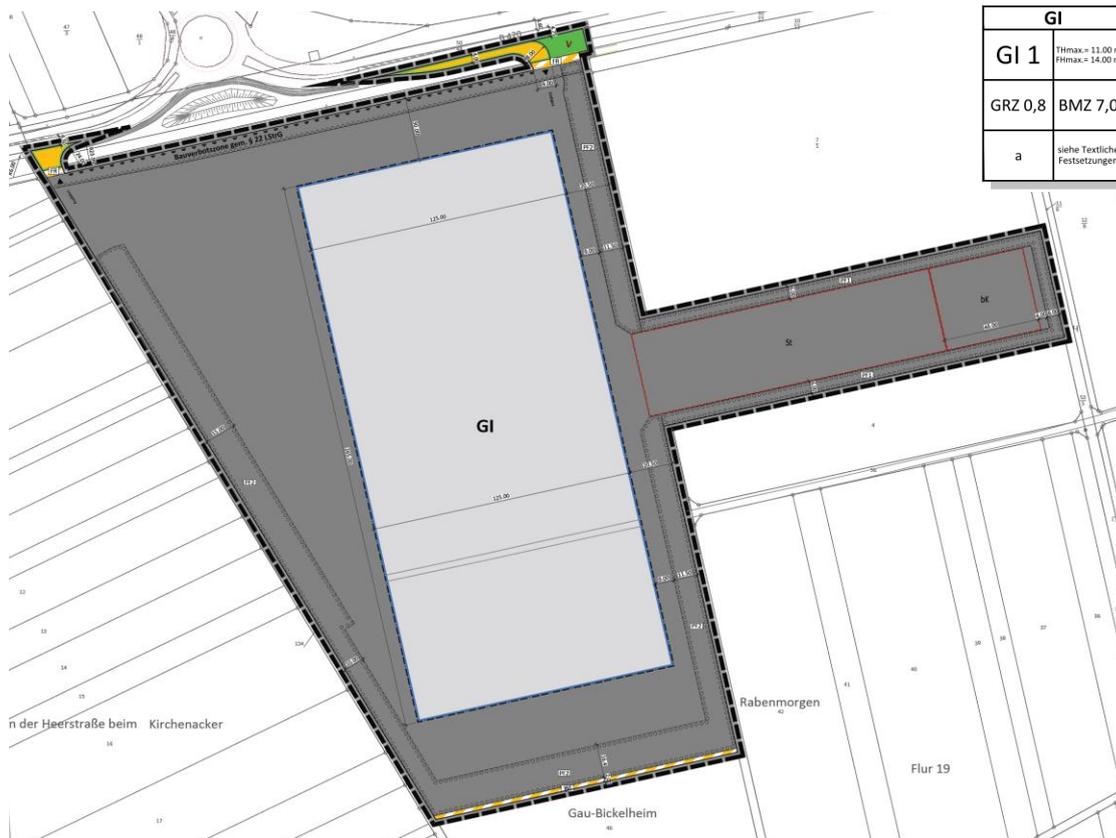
bislang rechtskräftiger Bebauungsplan "Auf der Wöllsteiner Höhe II"
